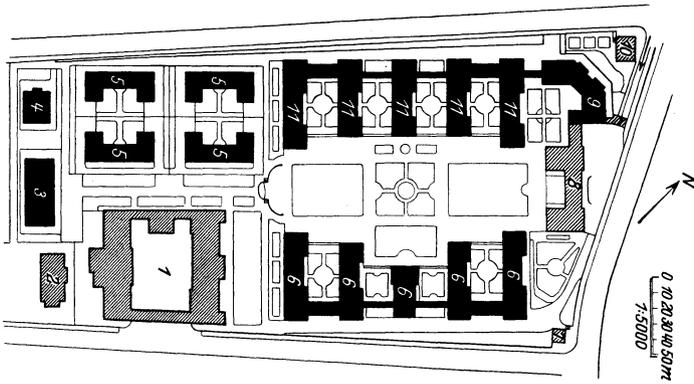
Berlin-Neukölln, städt. Krankenhaus für 405, später 1200 Betten.
